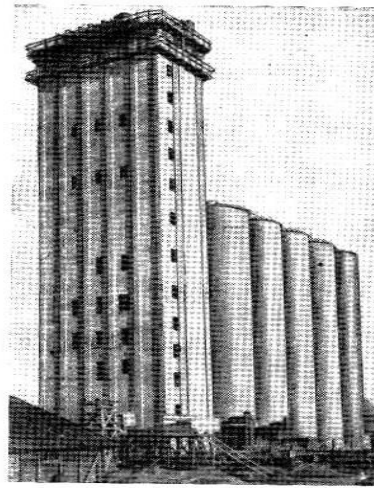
б – Відновлений елеватор (випрямлений силосний корпус та нова робоча вежа)
